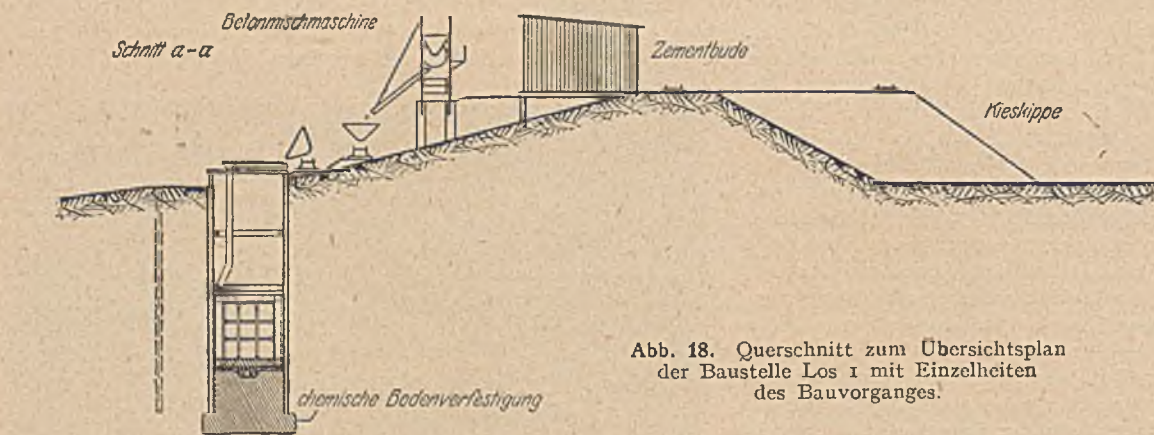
Querschnitt zum Übersichtsplan der Baustelle Los 1 mit Einzelheiten des Bauvorganges.
